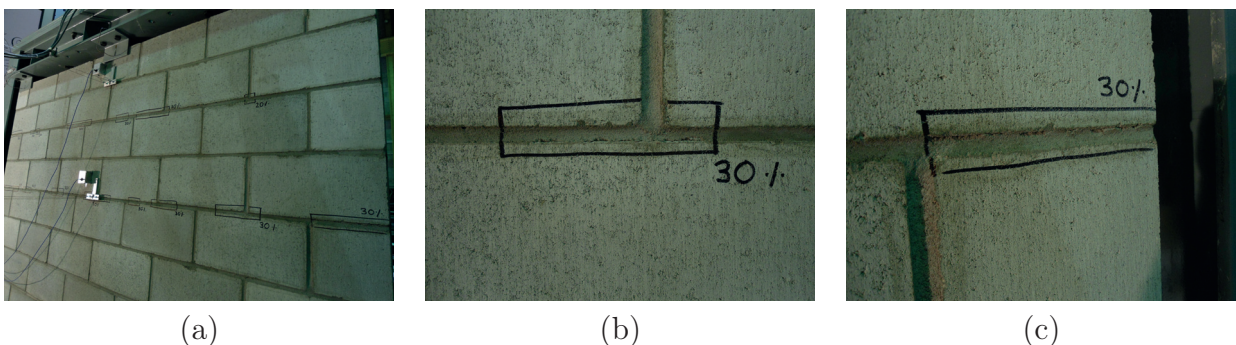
Photos de l'endommagement du mur 2 après l'essai MAL7-0.30 (a) vue globale de la façade avant (b) vue rapprochée d'un joint endommagé (c) vue rapprochée d'un joint endommagé à l'extrémité droite de la façade avant
